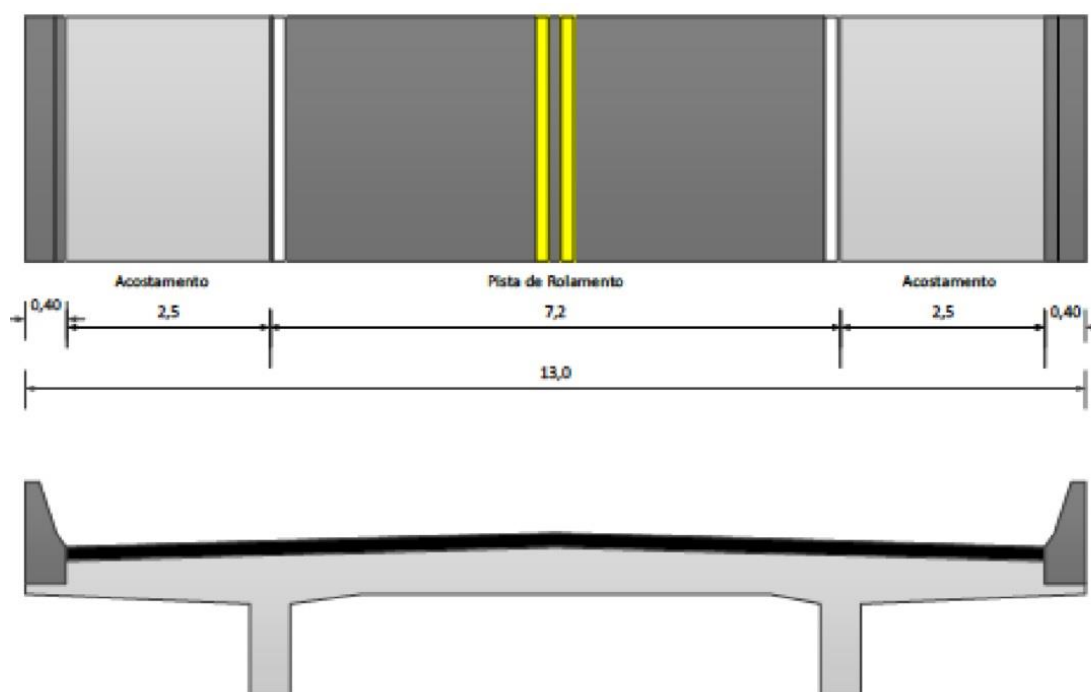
Seção transversal das pontes de concreto armado (PCA)
